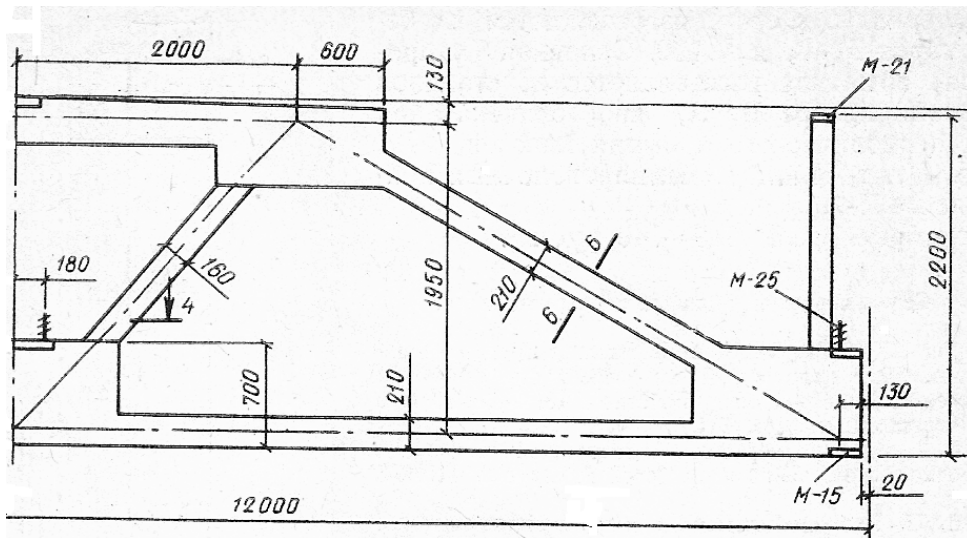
Подстропильная железобетонная ферма для скатных покрытий
